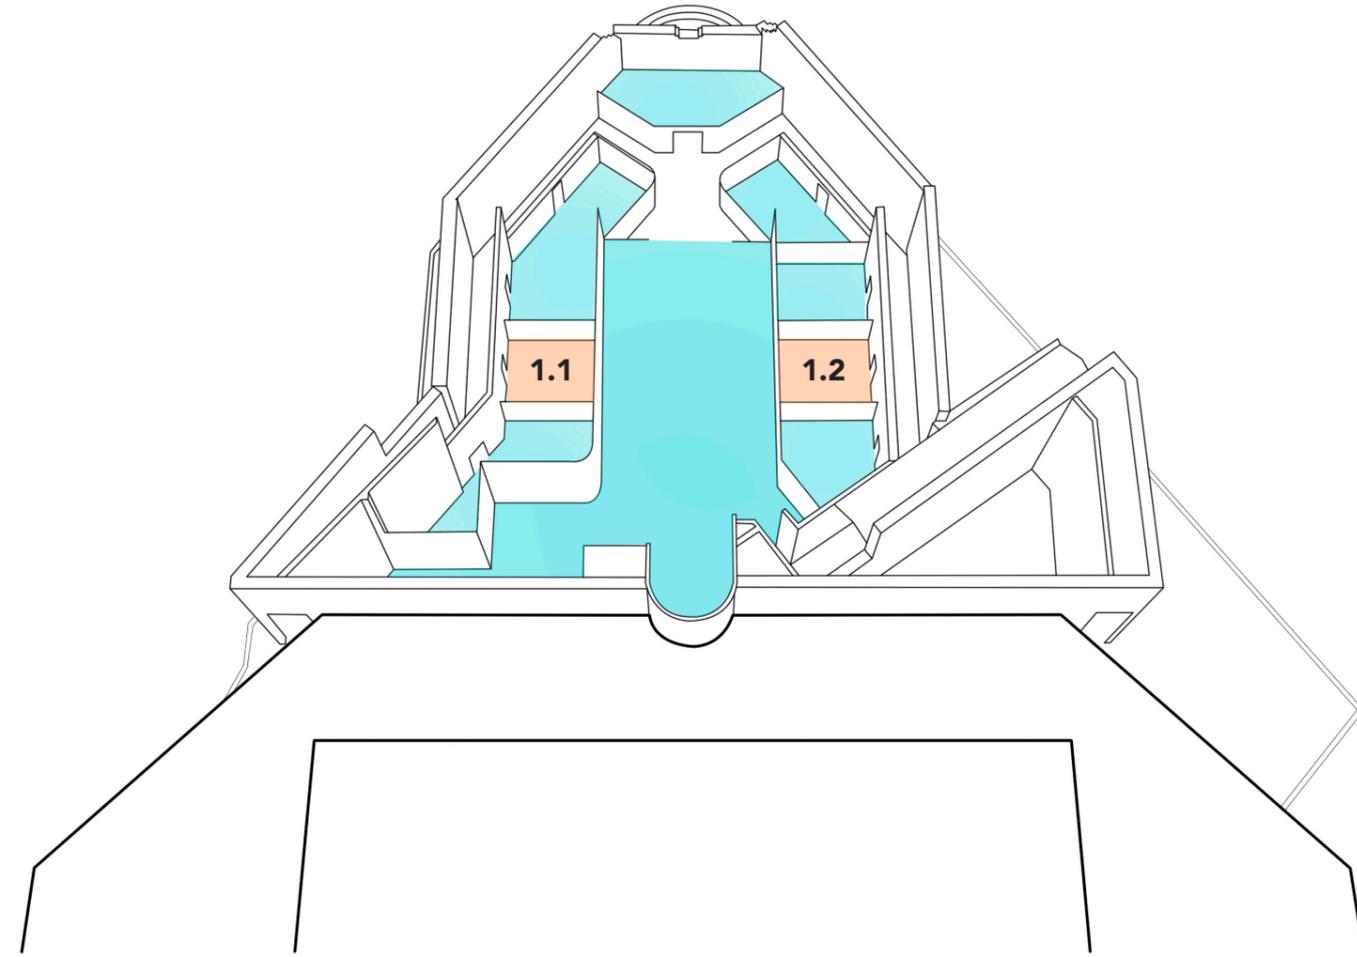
Plano de la planta baja de la Estación de Guaguas de San Benito.
